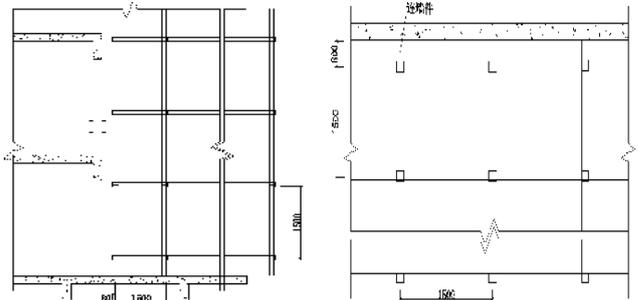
盘扣式脚手架计算剖面图 图 7 盘扣式脚手架平面图
